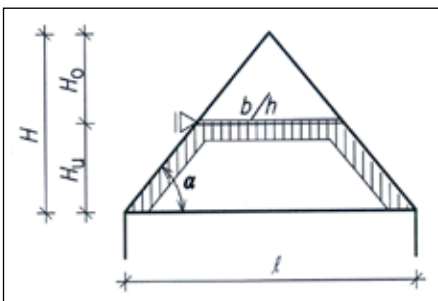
Schéma hambalkové soustavy bez půdní vestavby pro návrh střešní krokve, zdroj [2]
